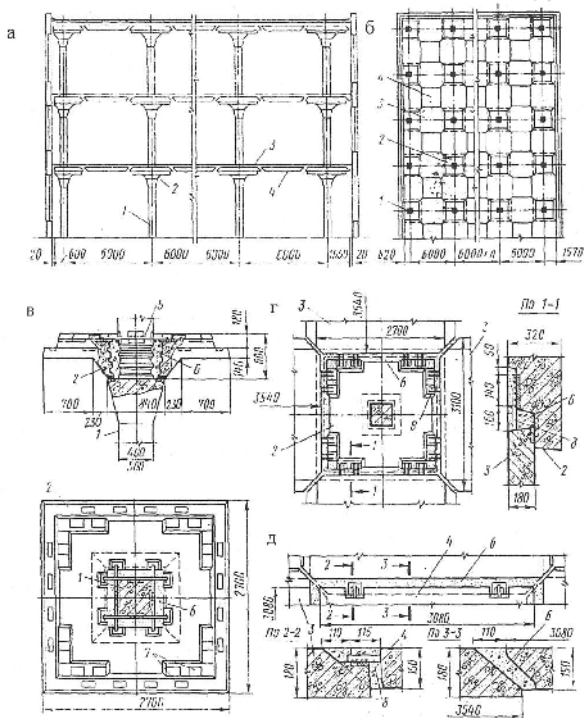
Схема многоэтажного здания с безбалочным каркасом: а – поперечный разрез; б – план междуэтажного перекрытия; в – соединение капителя с колонной; г – соединение лодовлонных плит с капителью; д – соединение пролетной плиты с лодовлонной; 1 – колонна; 2 – капитель; 3 – лодовлонная плита; 4 – пролетная плита; 5 – металлические стержни; 6 – замоноличивание бетоном; 7 – закладные детали; 8 – выпуски арматуры из плит
